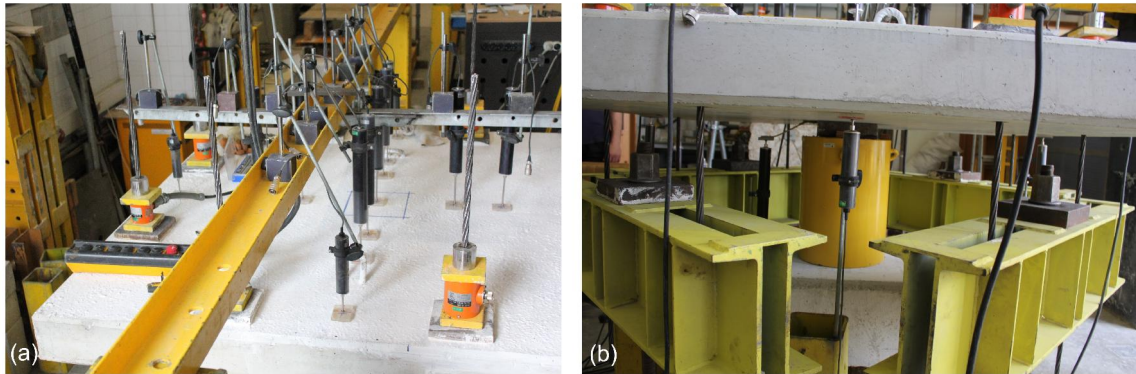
Fotografia da colocação dos defletômetros na laje: (a) Face superior; (b) Face inferior.
